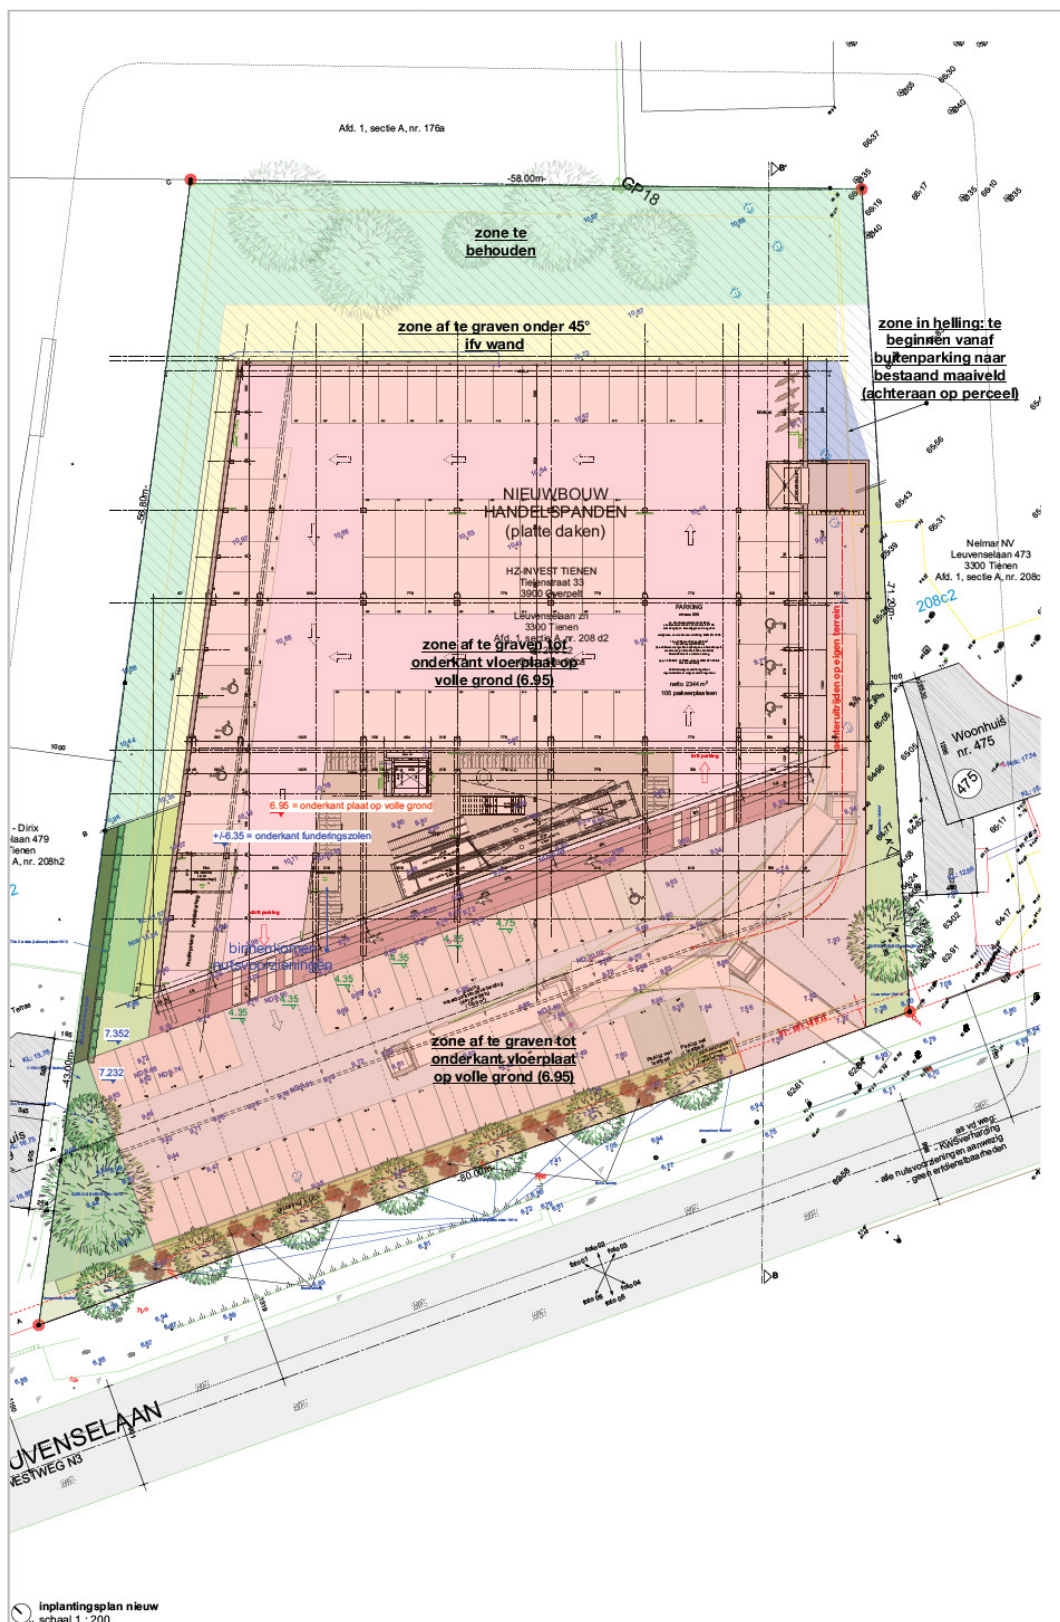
Overzicht van het geplande handelspand en bijhorende parking.
